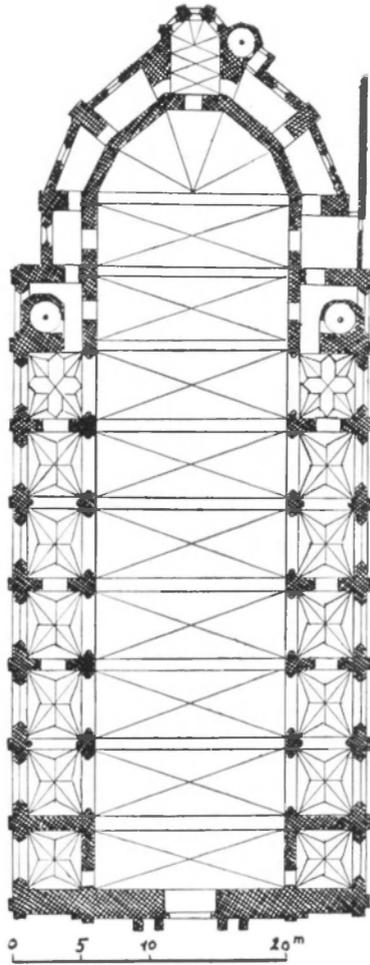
Saint-Omer. — Plan de la chapelle du collège des jésuites wallons.
